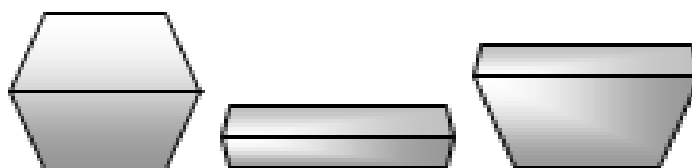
Профили бетонного блока плит ПБЗГУ
